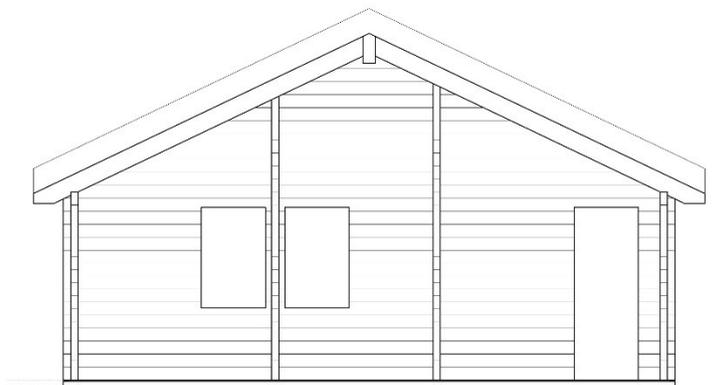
Prospetto di un edificio Log House con le pareti ortogonali che fuoriescono con le maschiature d'angolo.
